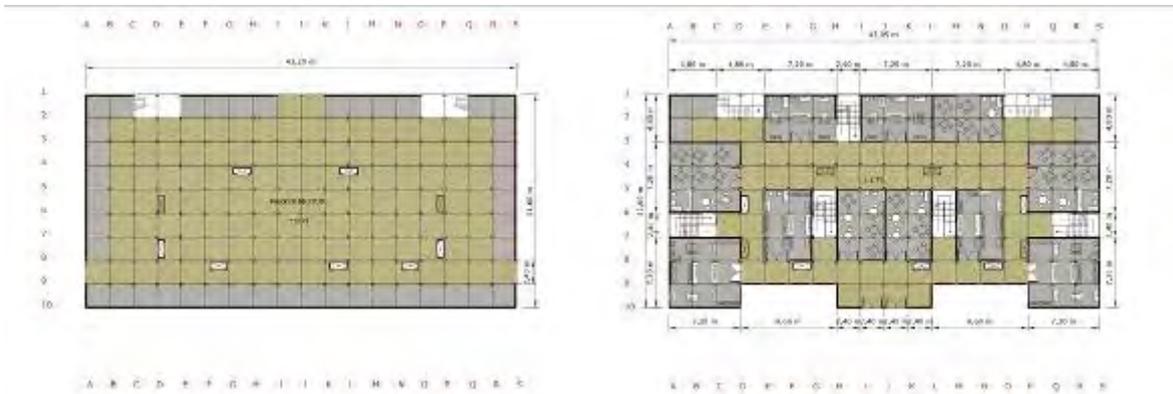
Denah Hunian Tipe Single Lt.3-Lt.4
